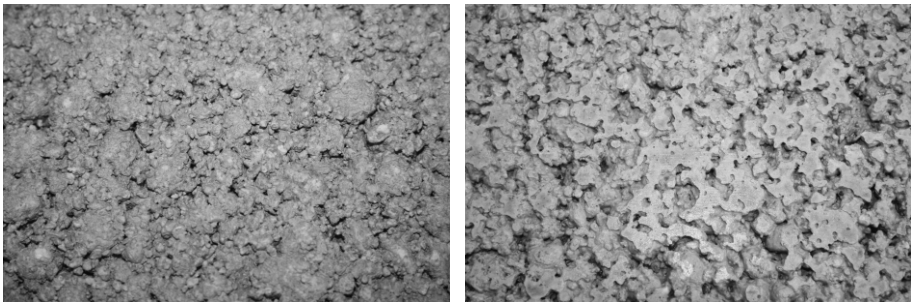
Betonoberfläche bei Wandelementen: links Betonieroberseite / rechts Schalenseite
